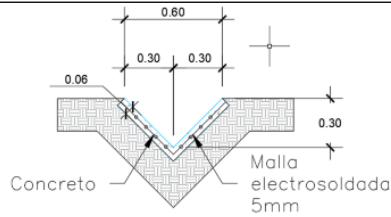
Sección de cuneta a construir en el PMRRA Ladrillera Alemana
